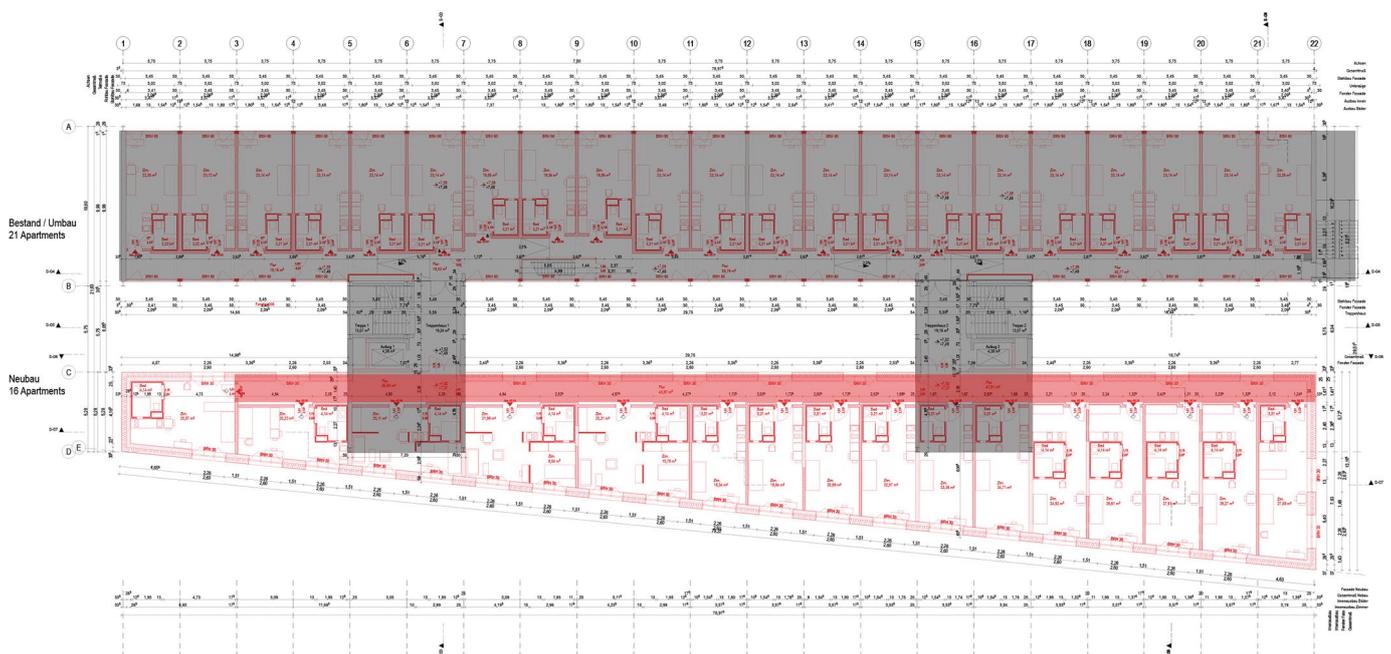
Grundriss gesamtes Ensemble: grau hinterlegt der Altbau, rot hinterlegt der neue Flurverlauf
